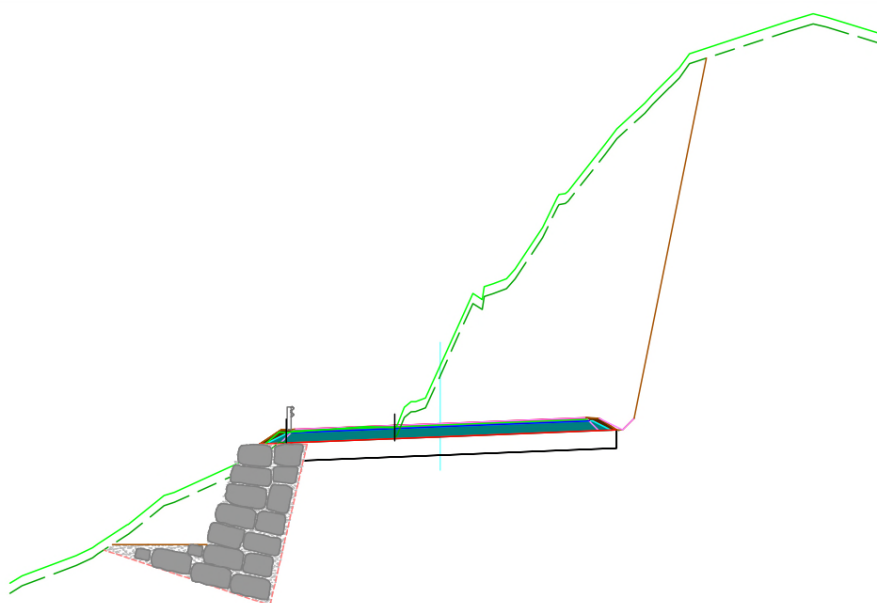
Ejemplo de sección en tramo con escollera (Pueyo, 2025).
